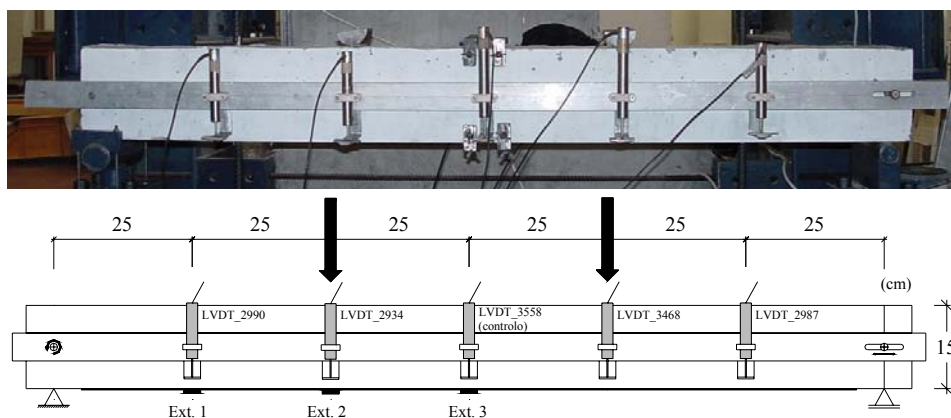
Disposição dos LVDTs e dos extensómetros eléctricos (Ext.1, Ext.2 e Ext.3)
